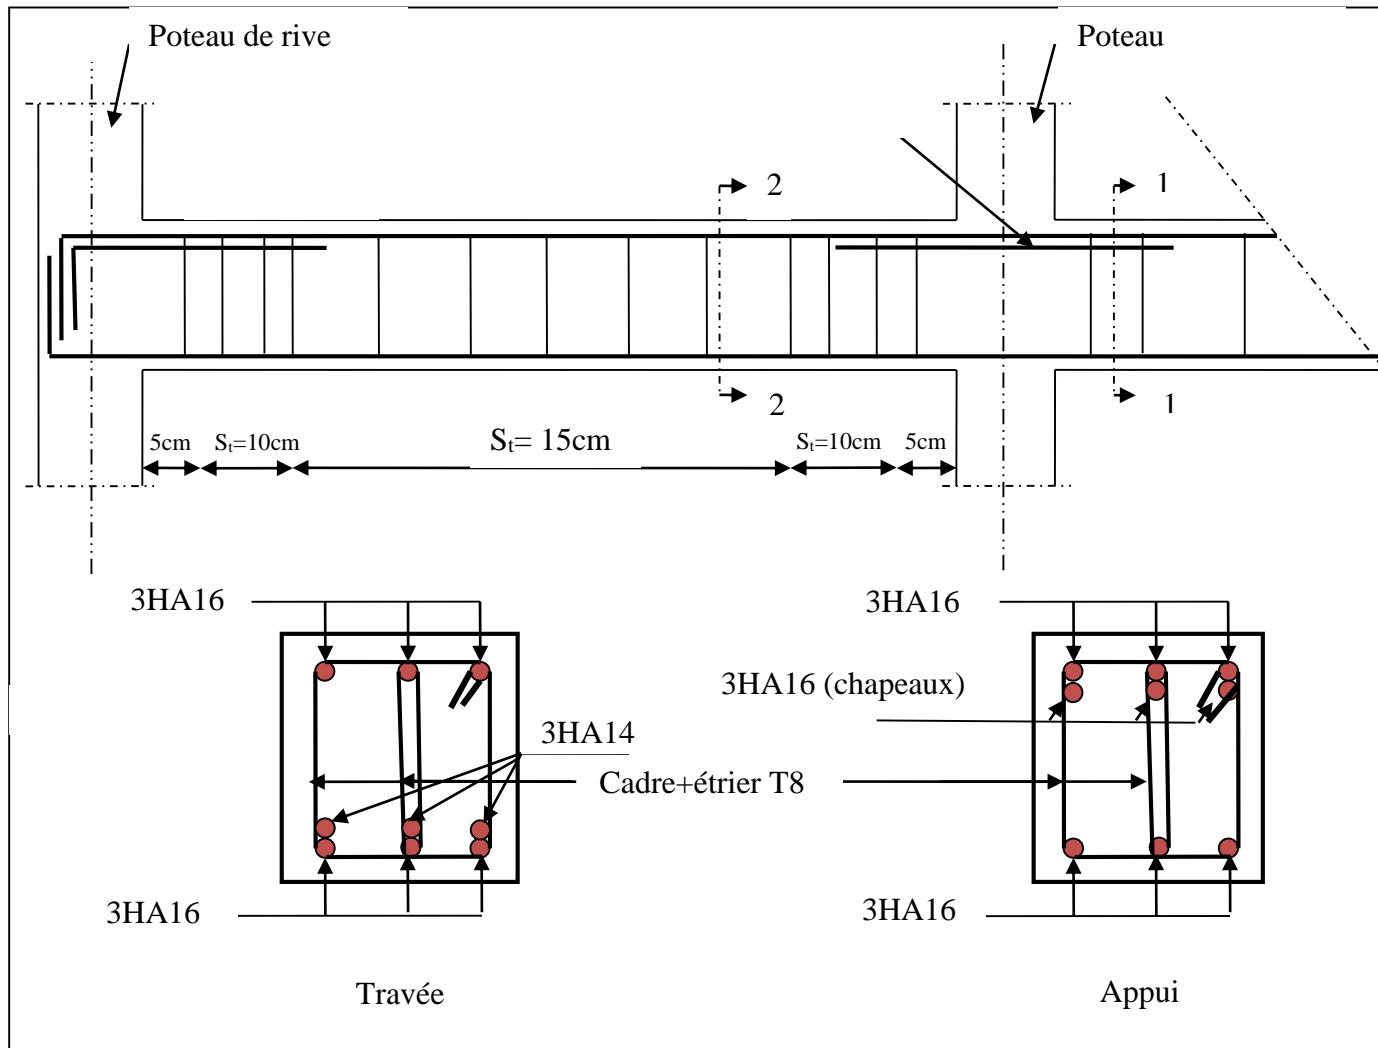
Schéma de ferrailage des poutres secondaires (Sous-Sol, Entre Sol 1 & 2).
